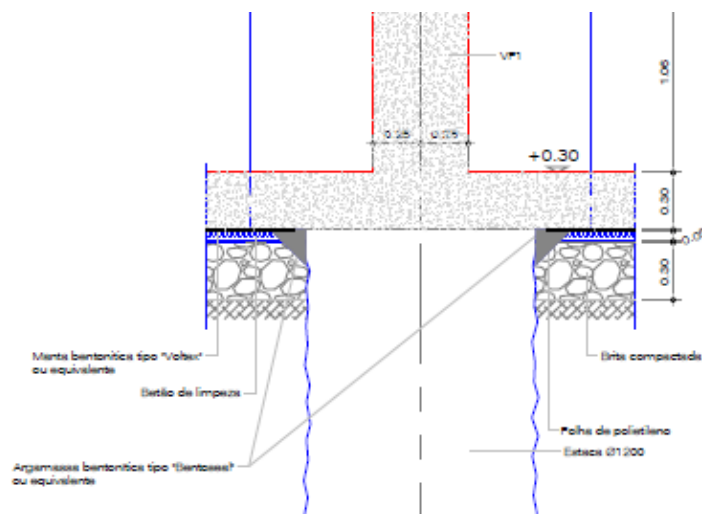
Corte da laje de fundo e respectivos pormenores de impermeabilização.
